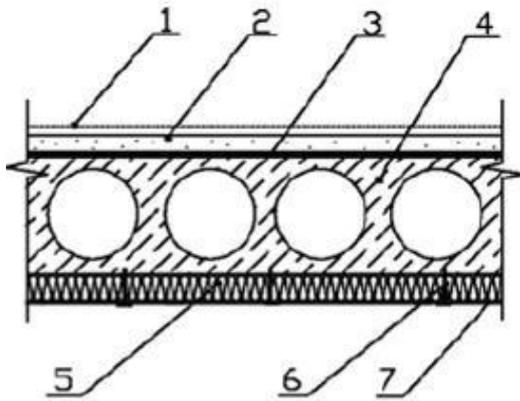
Улаштування теплогідрозвукоізоляції зі сторони першого поверху на перекритті із суцільних плит з застосуванням негорючого утеплювача
